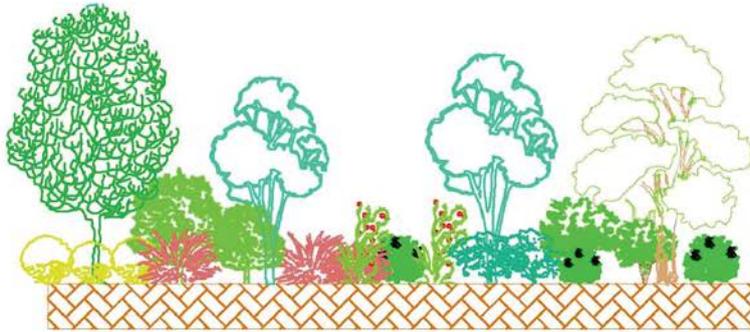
Interventi di Mitigazione a Verde del Terminale GNL, Planimetria
